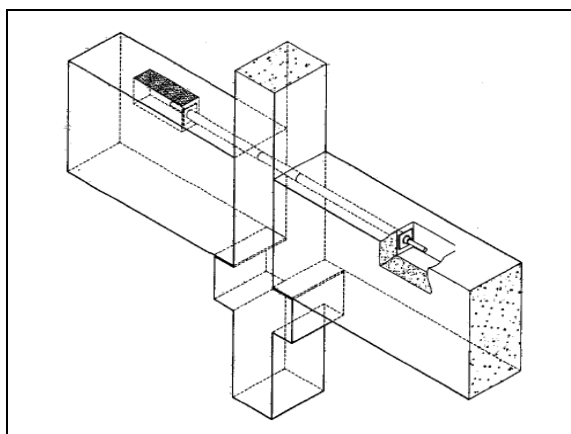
Ligação por consola curta de betão e pré-esforço (PCI, 1999)
